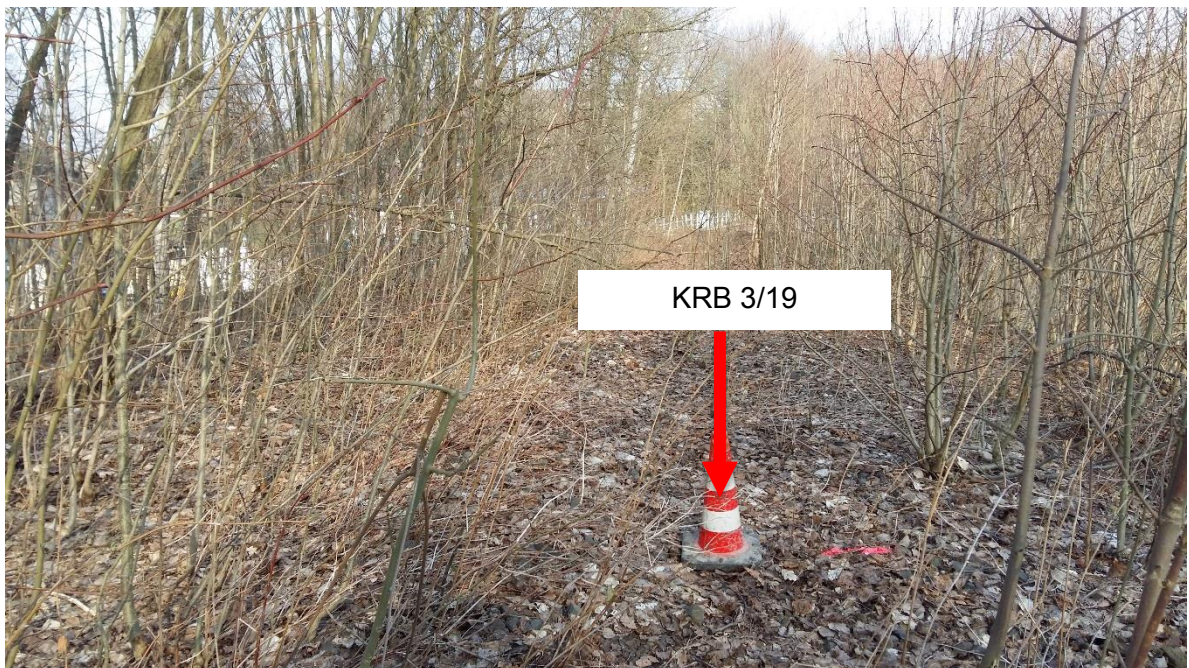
Lage des Aufschlusspunktes KRB 3/19
